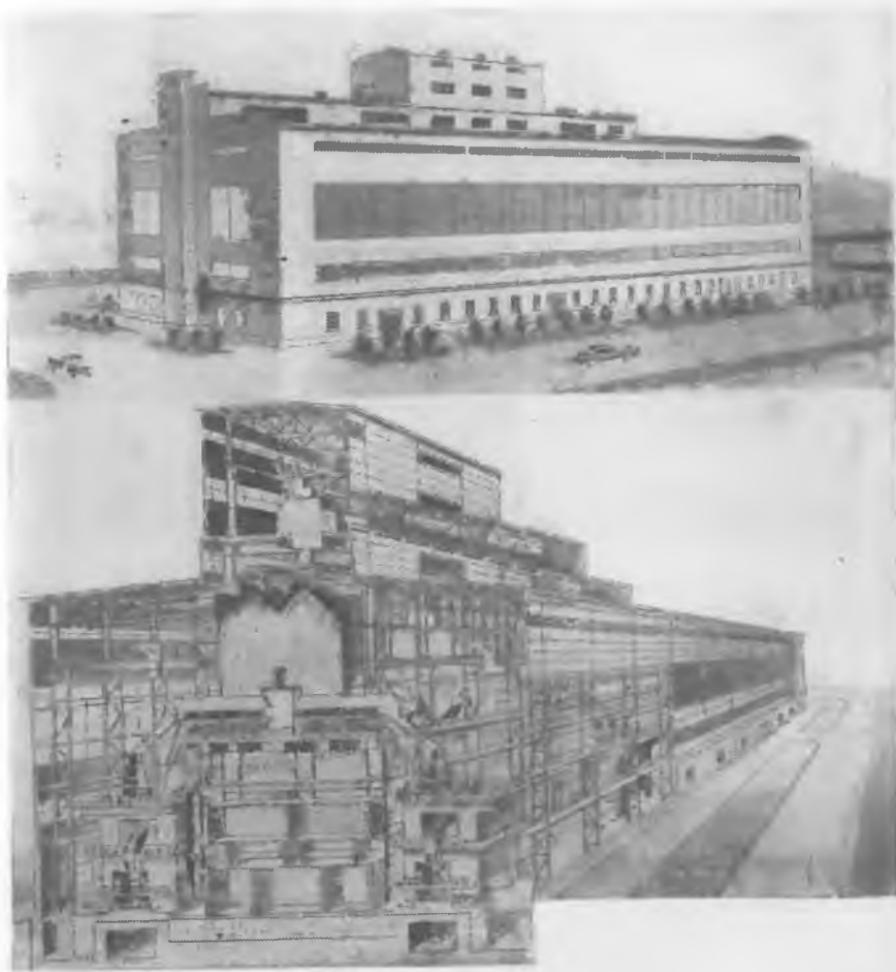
Корпус среднего и мелкого дробления; внешний вид (вверху) и разрез (внизу) («Уралмеханобр»).
